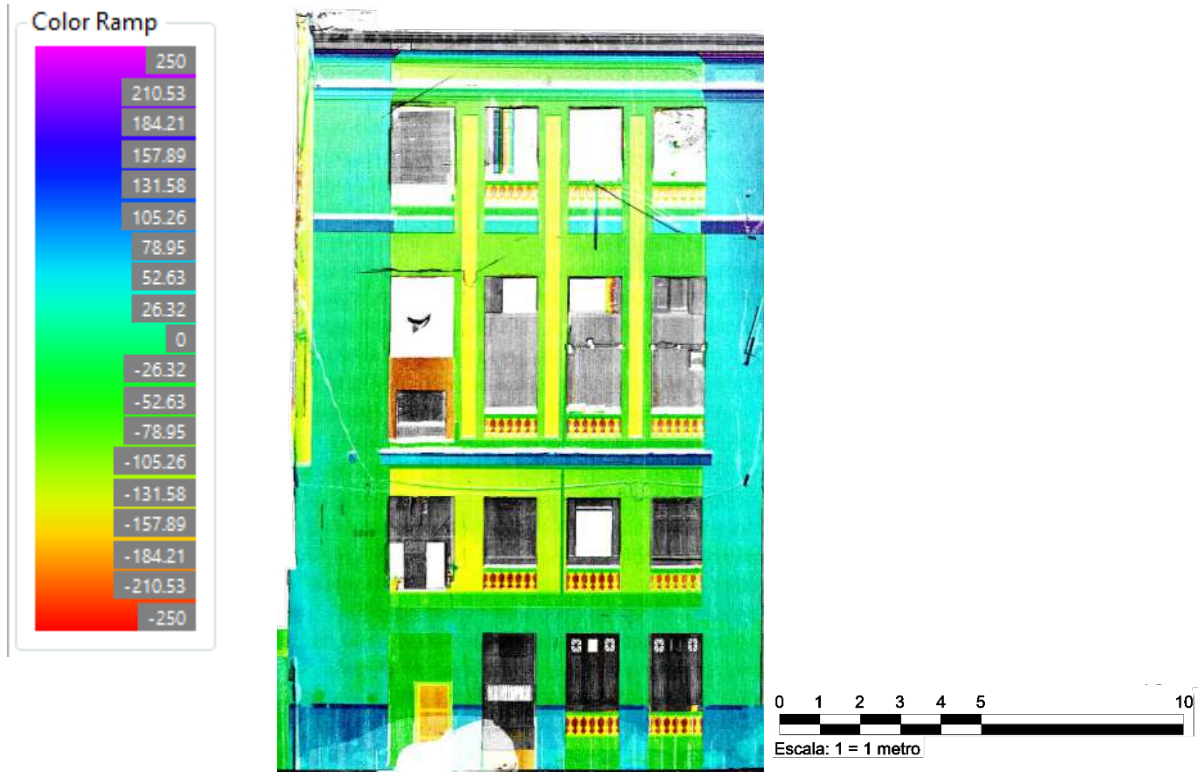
Modelo de elevación de la fachada hacia la calle Industria.
